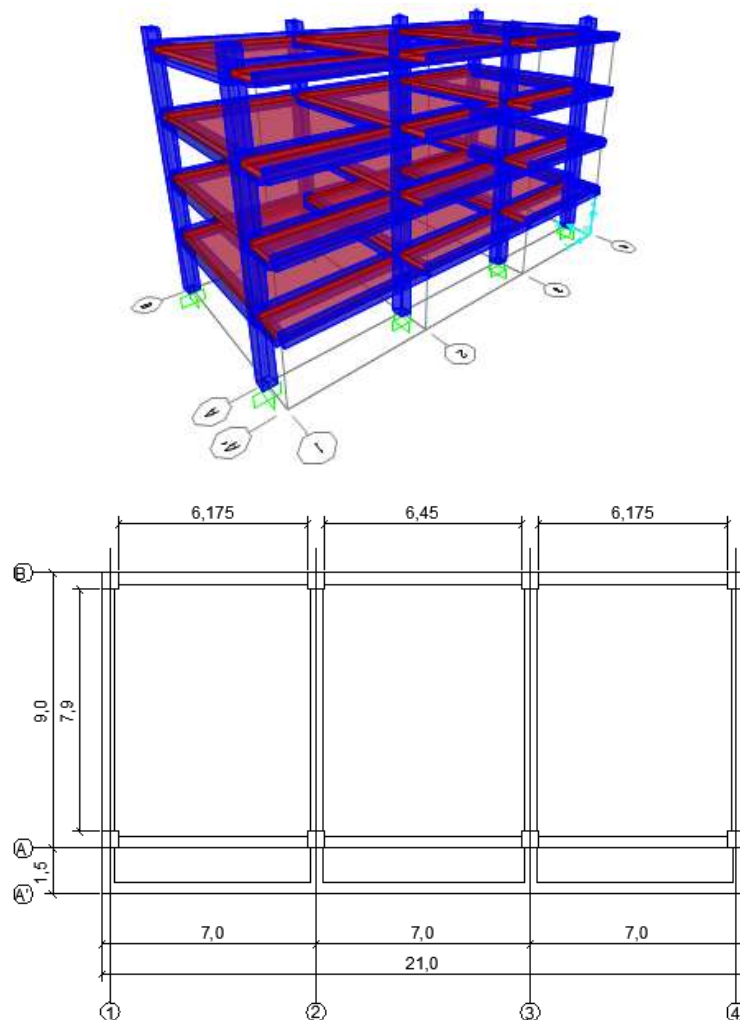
Modelo de la sección *Aulas* y vista en planta
